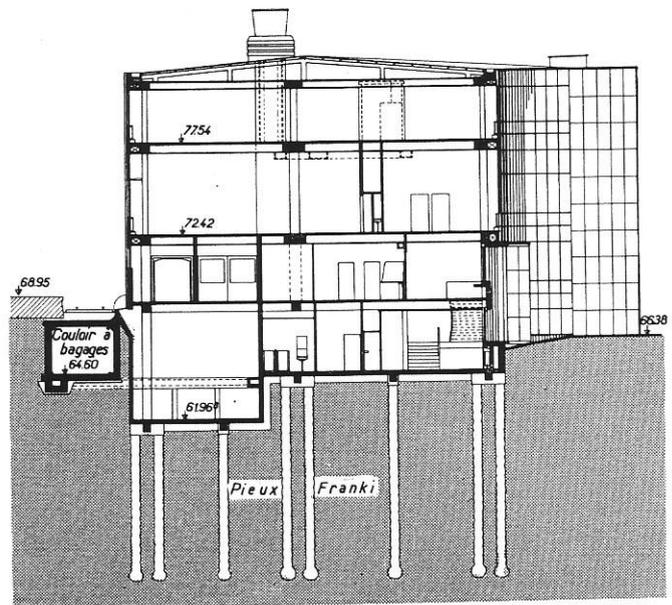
COUPE TRANSVERSALE BB SUR LE BÂTIMENT DES POSTES. Noter, à gauche, le couloir sous voies, en béton armé.
